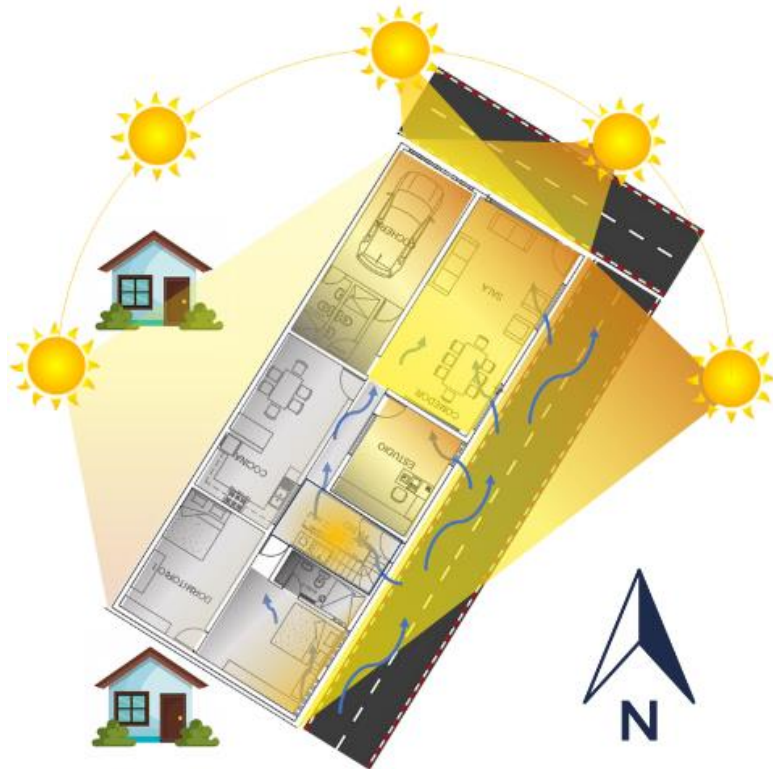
Plano de la vivienda KA – Nivel 1er piso
